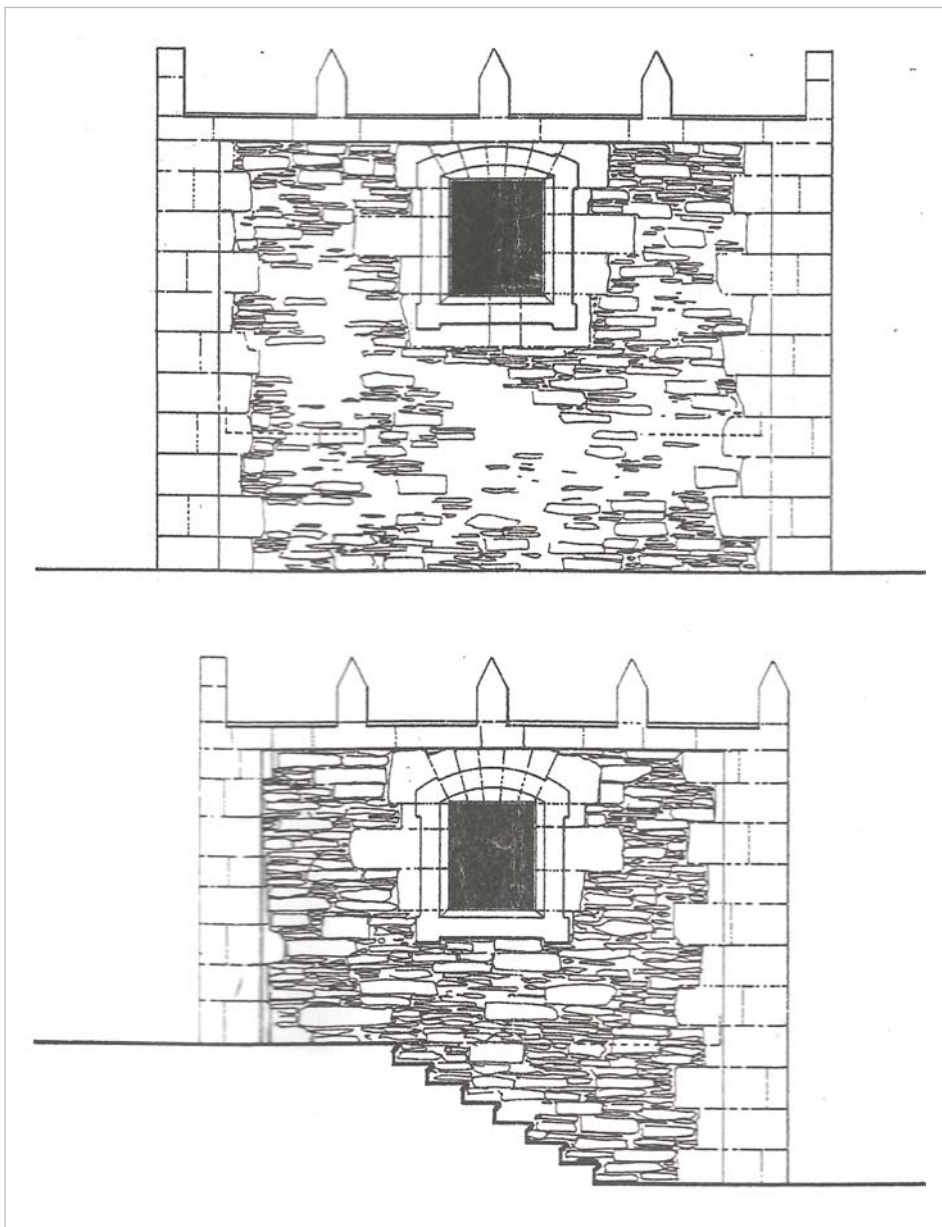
Alzado sur y oeste del Pabellón de don Pío (F. Cebrián)
